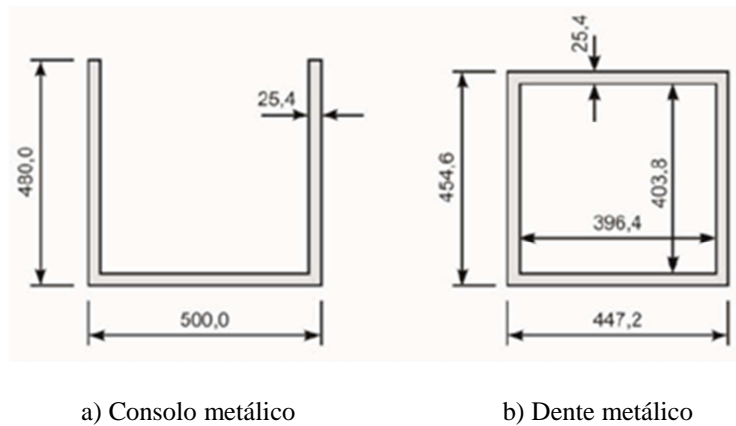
Dimensões da seção transversal dos elementos da ligação viga-pilar [OLIVEIRA (2009)].
